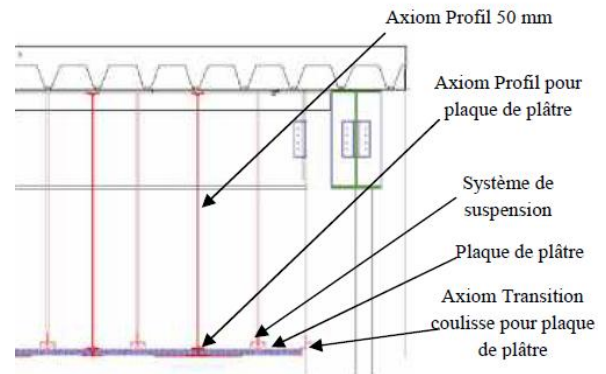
Détail n°07: Détail les faux plafonds (1 :5)
